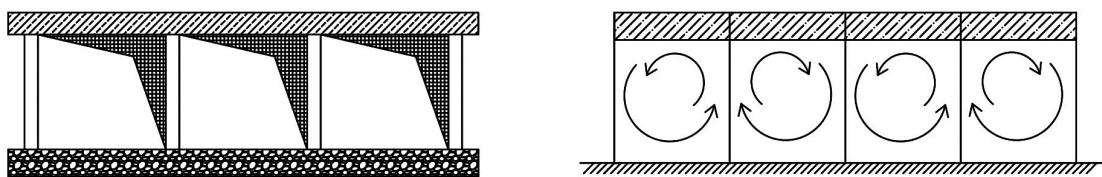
Реальная конструкция тепловых покрытий и их схема работы
